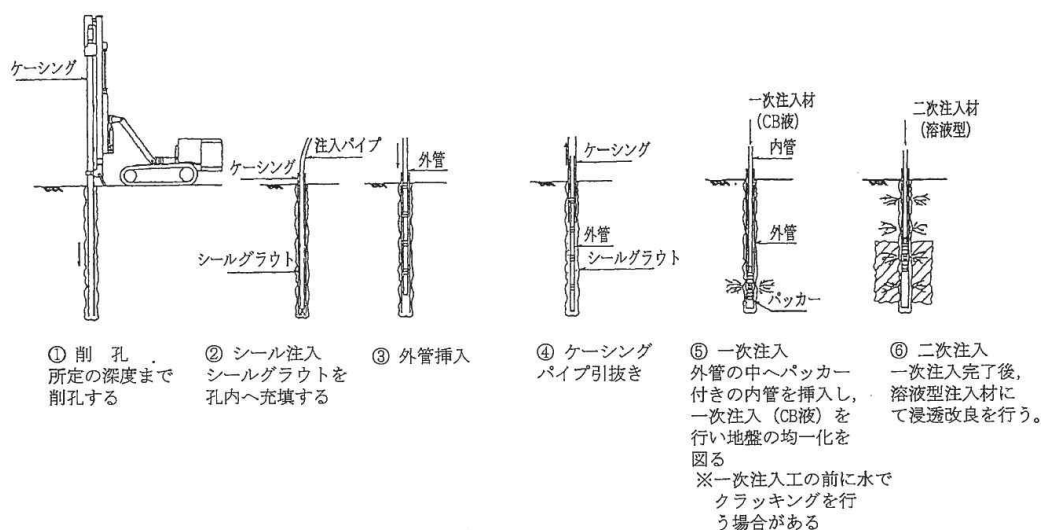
ダブルパッカ工法の施工順序⁷⁾
